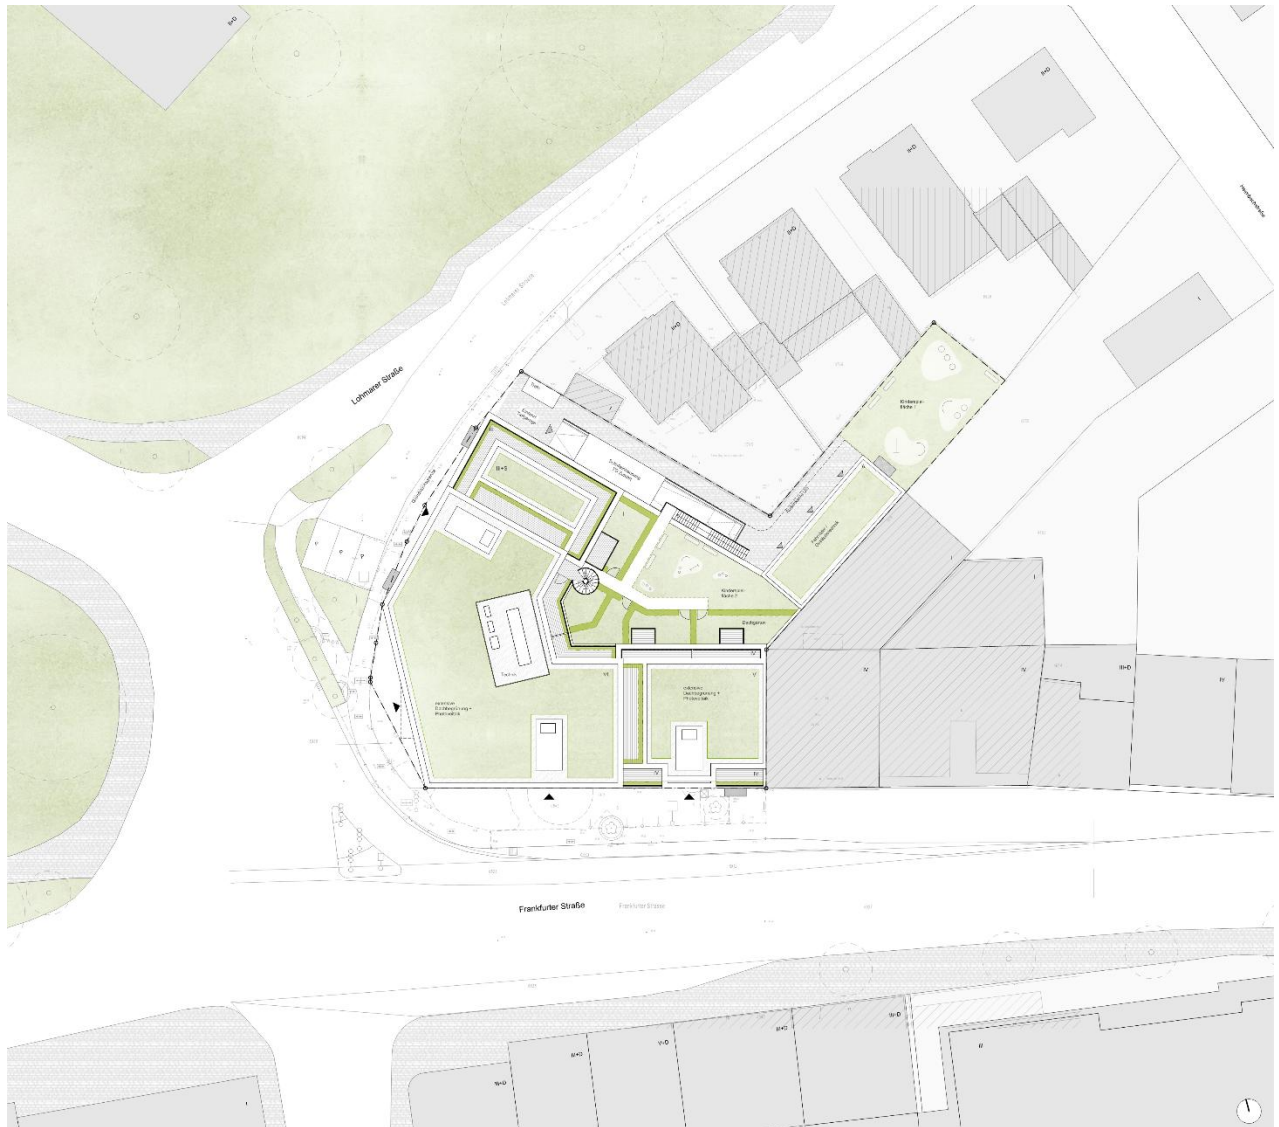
Lageplan des Planobjekts (genordet, ohne Maßstab. Quelle: KASPAR KRAEMER ARCHITEKTEN GMBH, 26.05.2025). Das Plangebiet ist schwarz gestrichelt umrandet.
